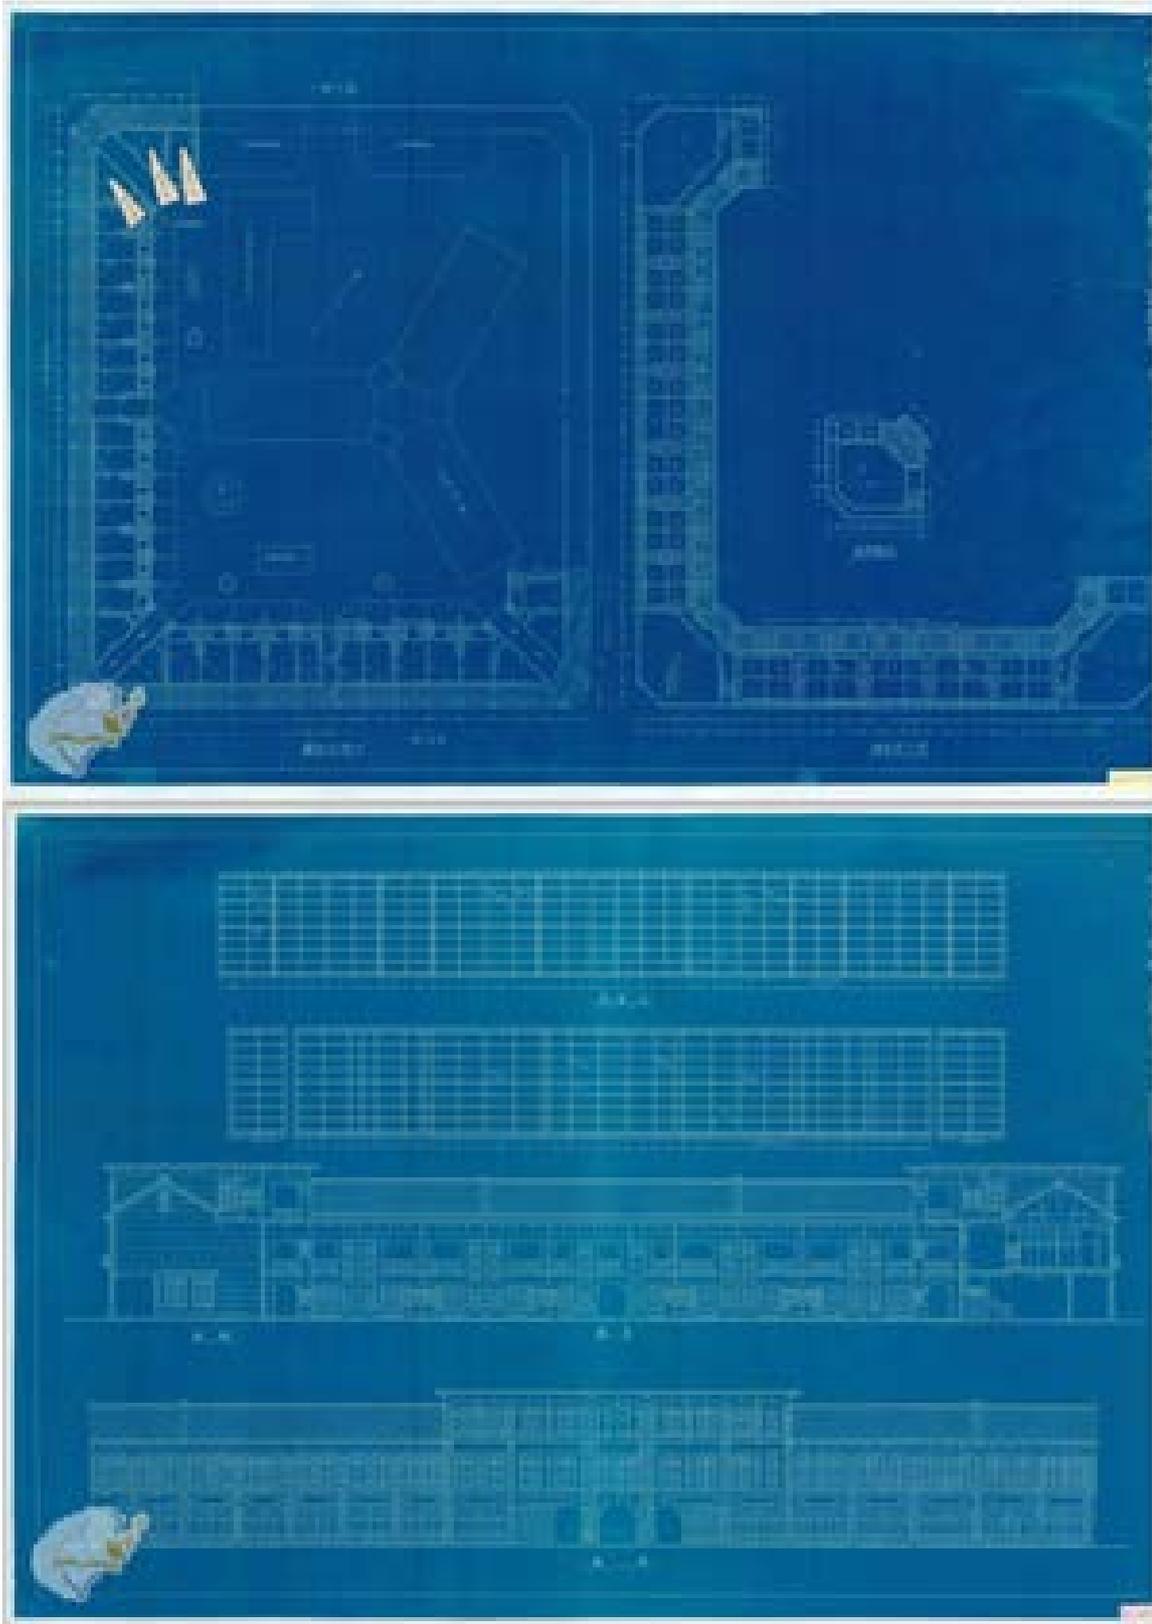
：日治時期臺中市第一消費市場市設店鋪平面與立面圖
